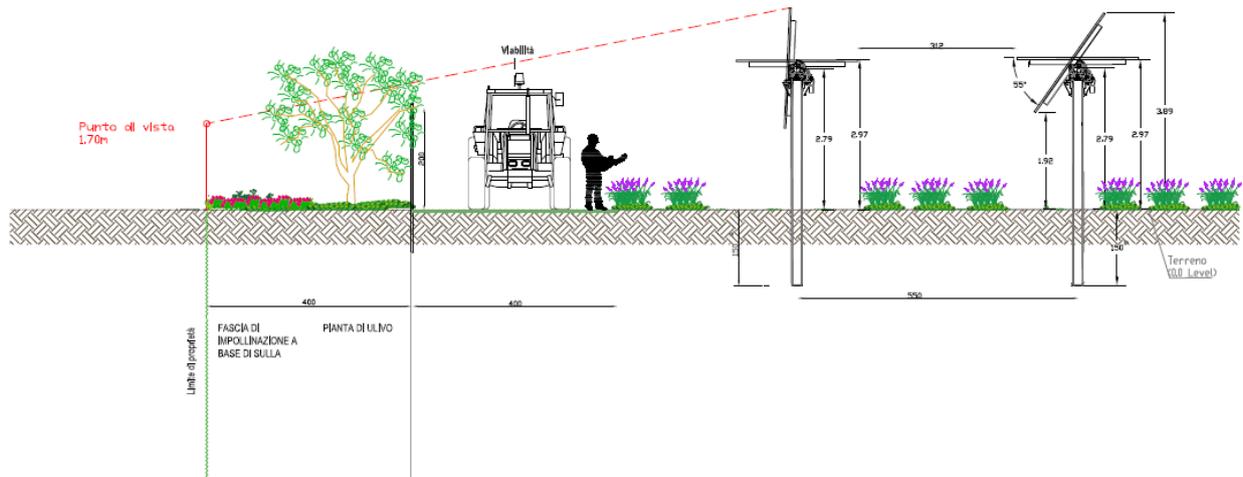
Sezione tipo della soluzione adottata con tracker alto (altezza in corrispondenza dell'asse di rotazione pari a 279 cm) ed interasse di 5,5 m
